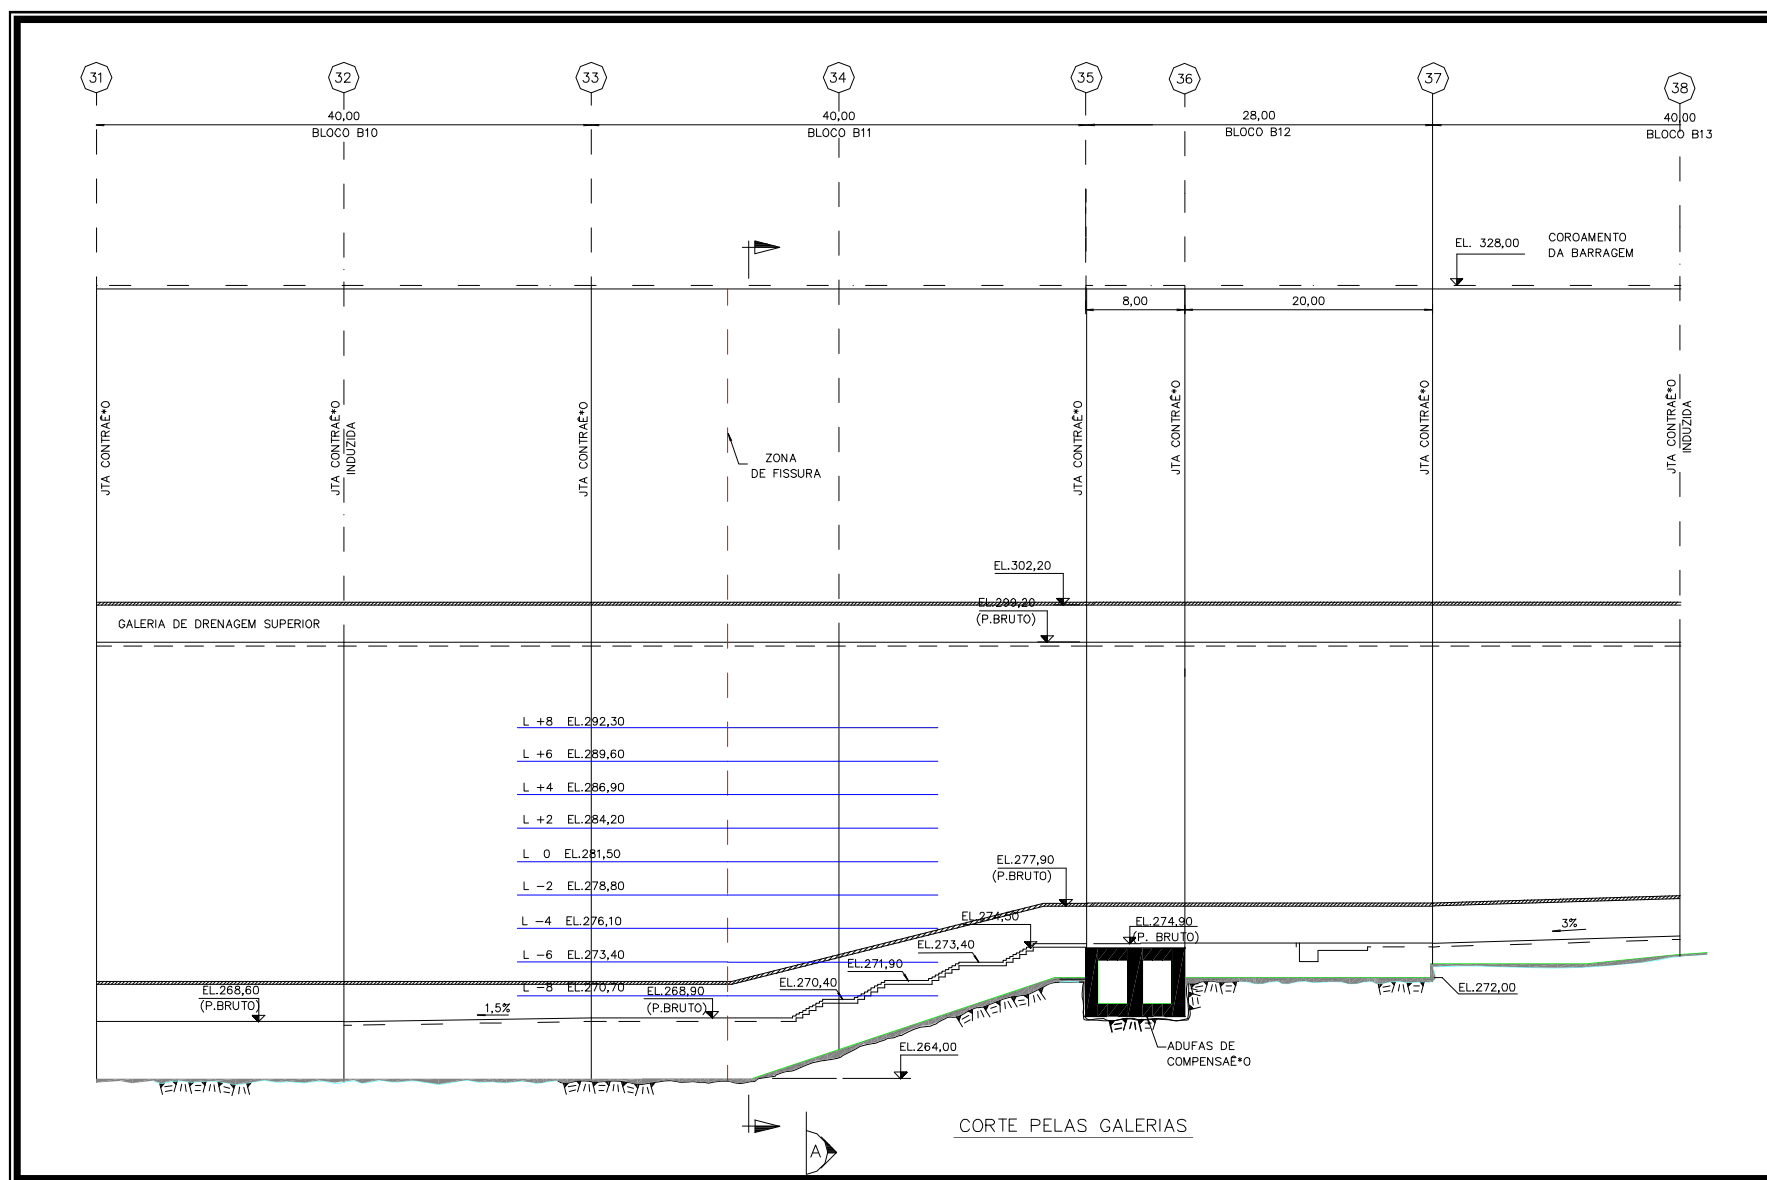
Corte longitudinal esquemático com o posicionamento das linhas de ensaio.
